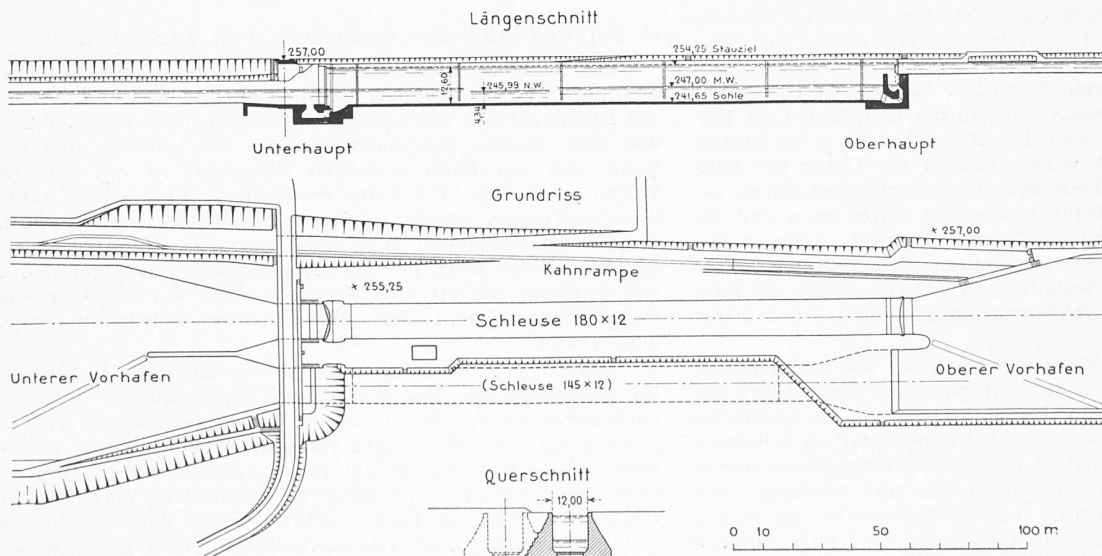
Schiffahrtsschleuse 180 × 12 m, Längsschnitt, Situation und Querschnitt, Situation mit Kahnrampe und späterer zweiter Schleuse 145 × 12 m. Masstab 1 : 2500
